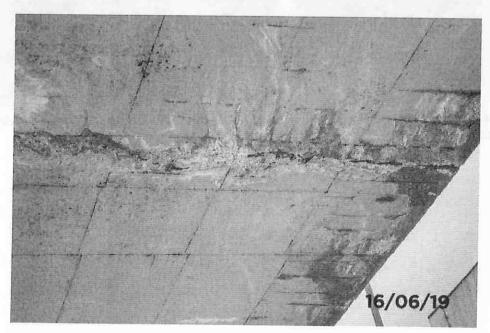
Detalhe na laje de trincas, eflorescência e armadura exposta.
